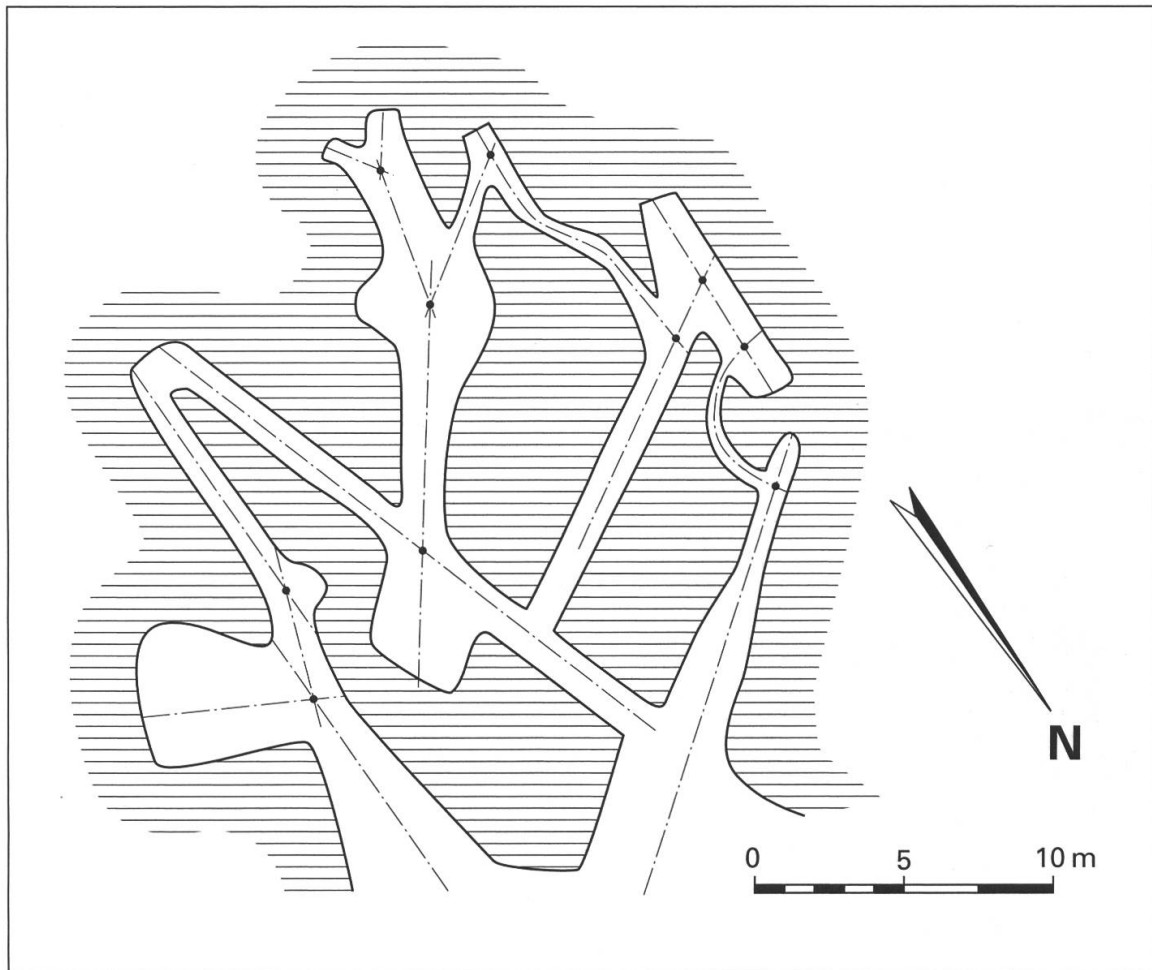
Grundriss von Grube II (massstäbliche Skizze).
